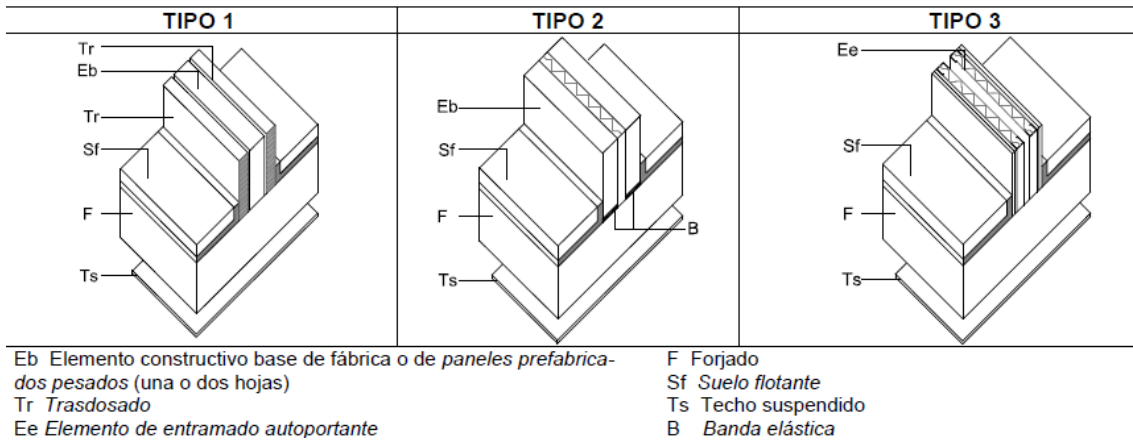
d. Tipos de elementos de separación. Fuente [N1] DB HR.
